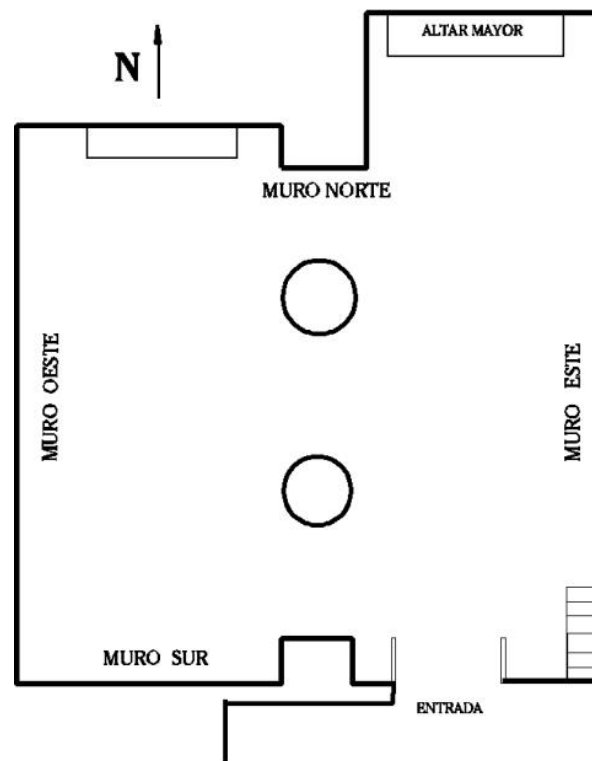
Plano de planta del interior de la Ermita de la Magdalena.
